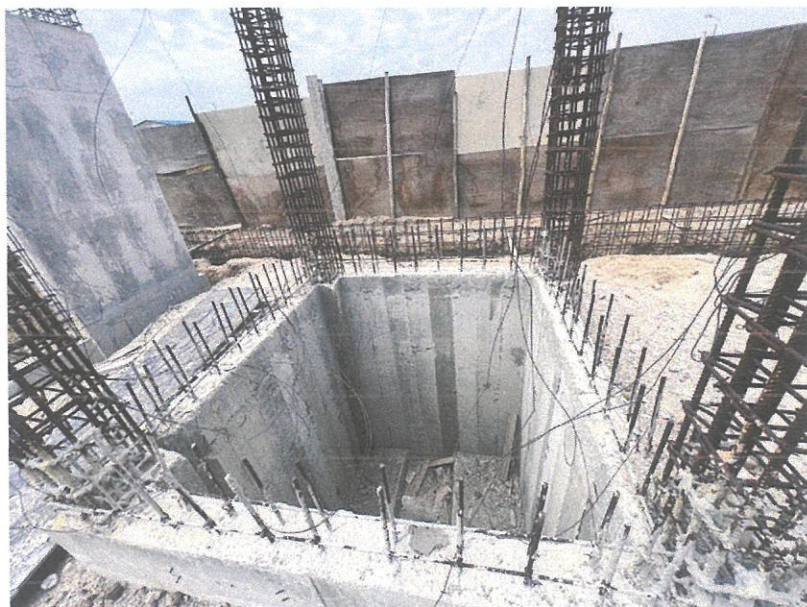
Vista de la Cisterna ejecutada sin terminar y con el acero expuesto
